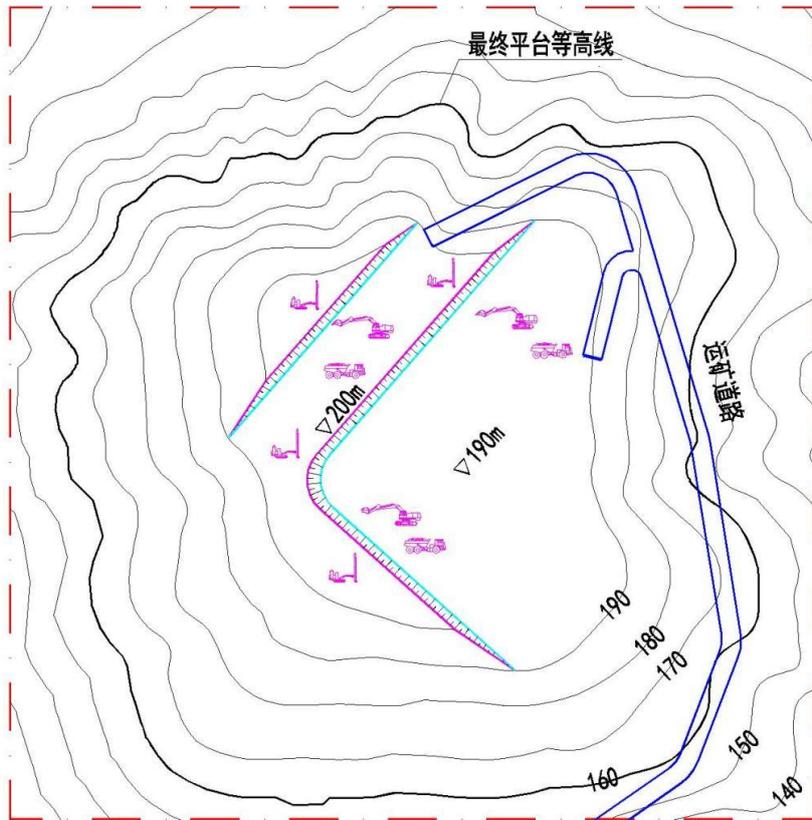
孤山型山坡露天矿山开采平面示意图
